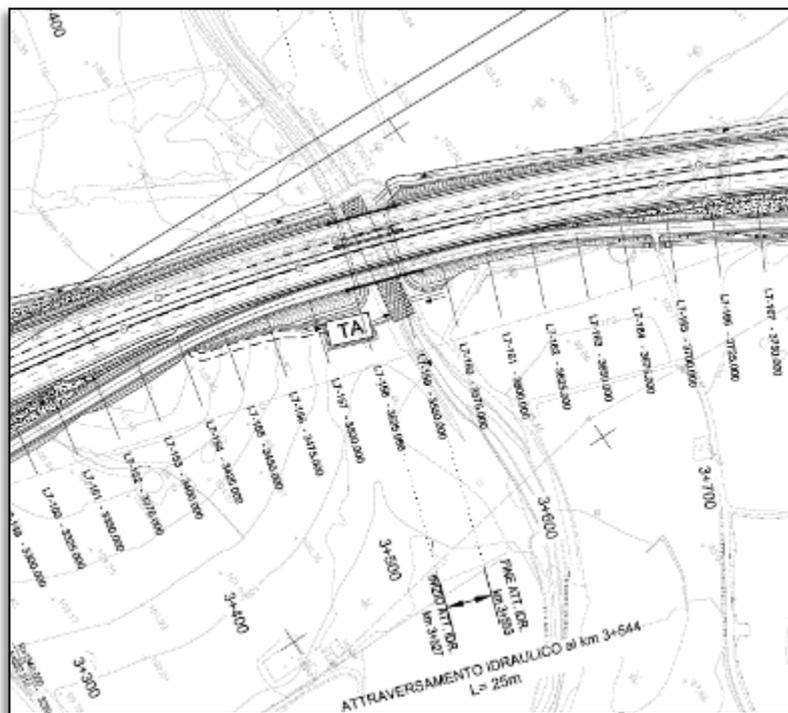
Lotto 7 attraversamento idraulico al km 3+544 del Torrente Canale – Stralcio Planimetrico
